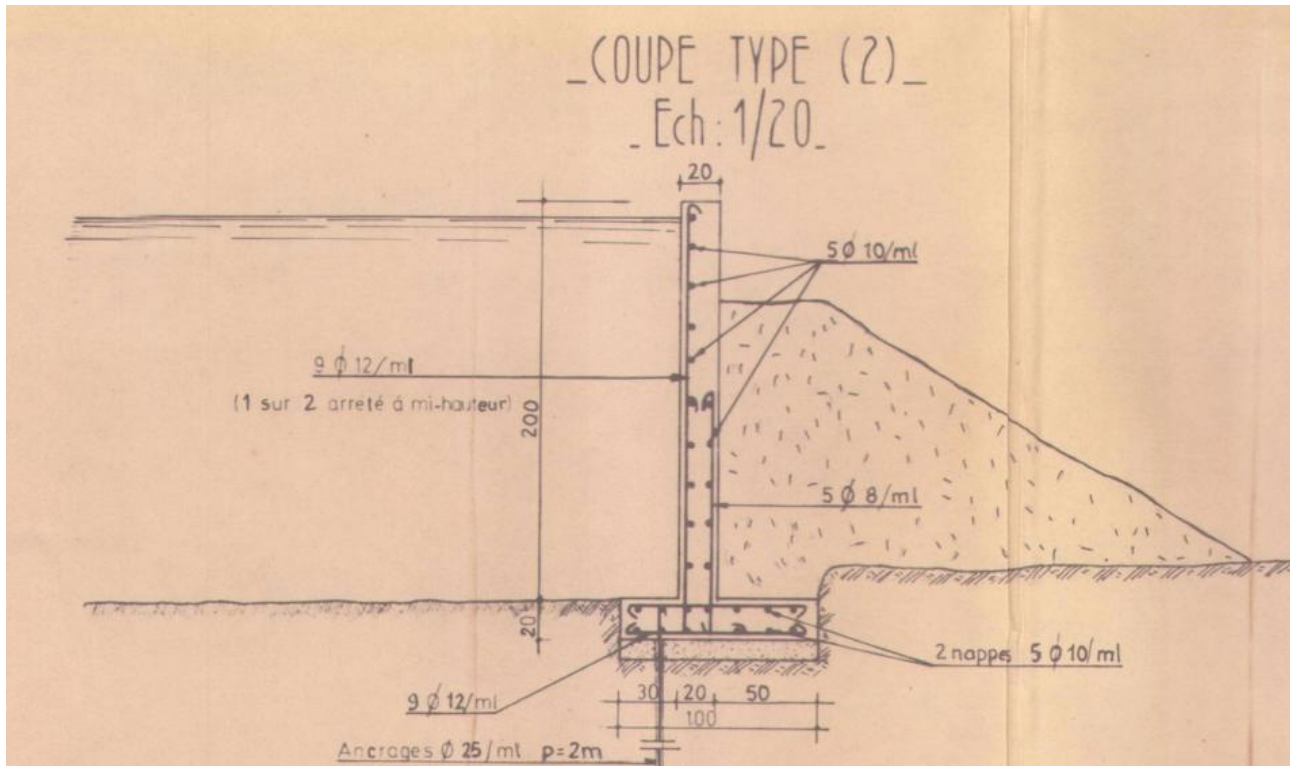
Ferrailage des bajoyers dans la partie du coursier excavé au rocher - Plan de projet
